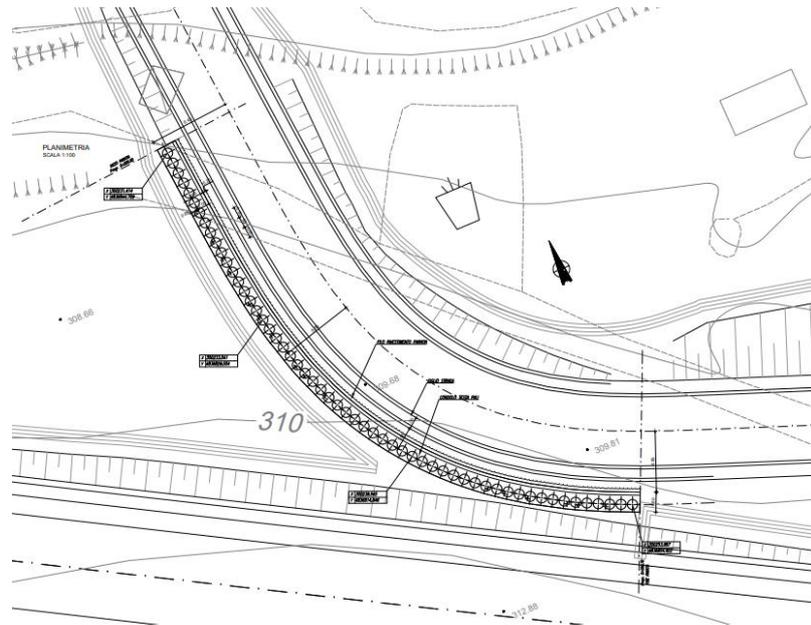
Planimetria paratia OS5 (viabilità secondaria 2)
